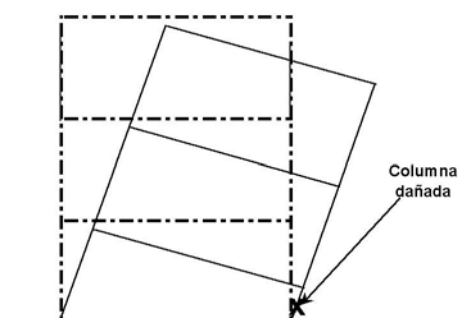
Colapso de toda la edificación por falla en columna del primer piso
